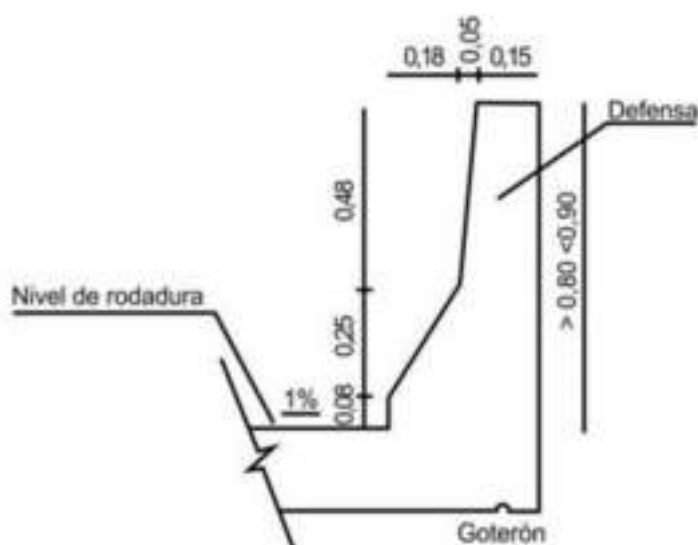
Figura 3-7. Defensa tipo New Jersey
